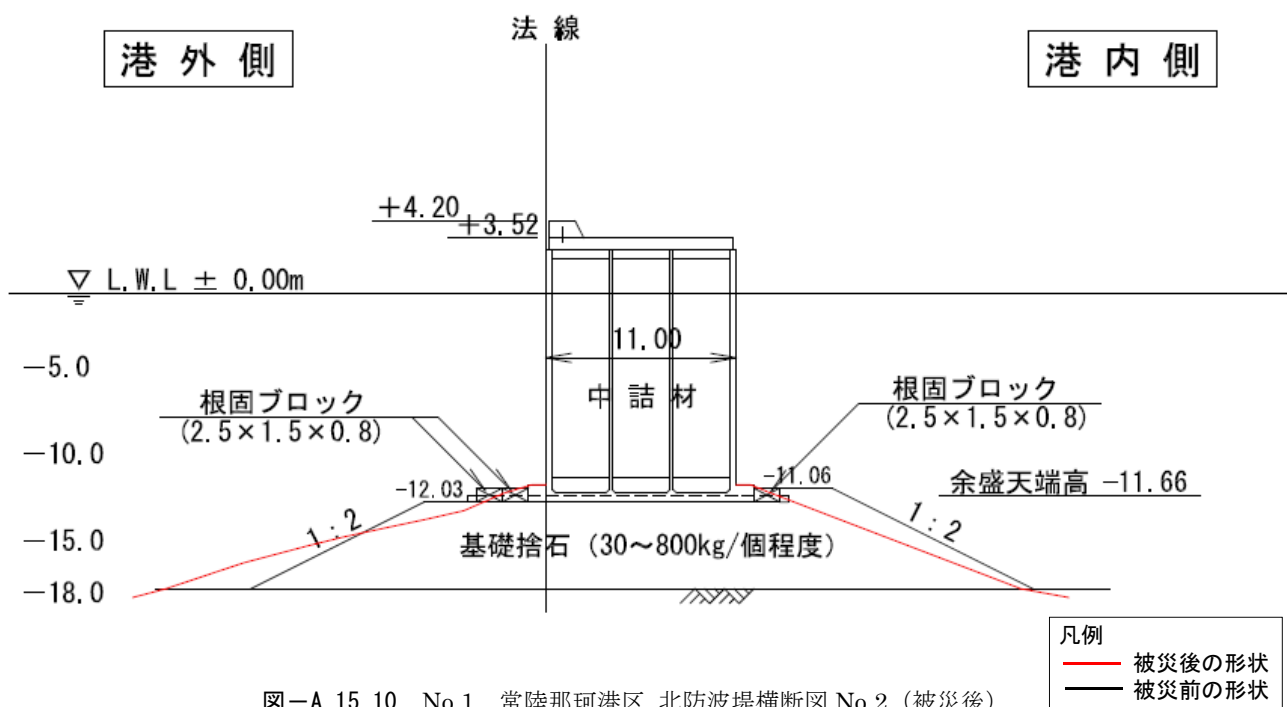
10 No.1 常陸那珂港区\_北防波堤横断面図 No.2 (被災後)
